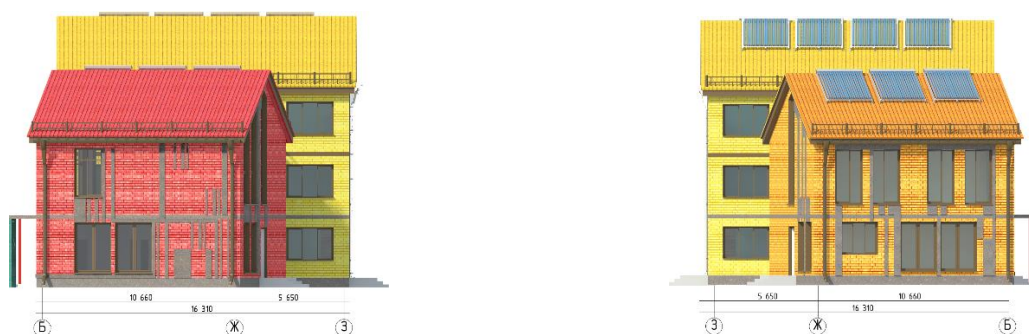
а) фасад в осях Б-3; б) фасад в осях 3-Б
